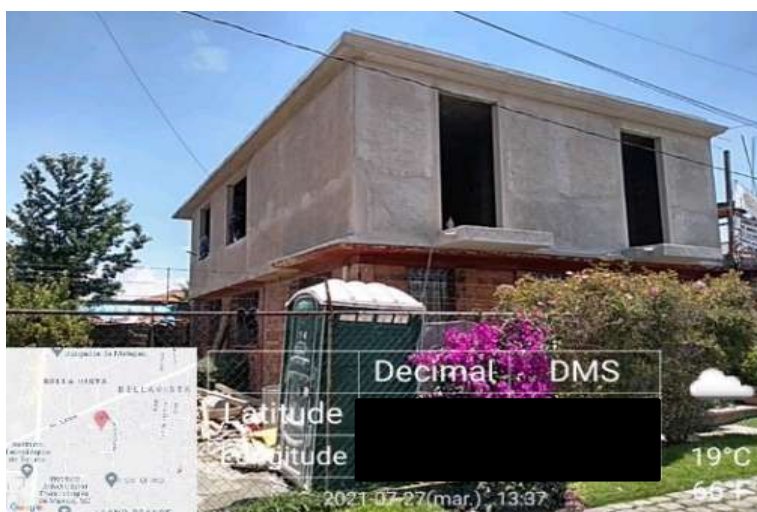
Fachada de la vivienda con muros de primer nivel desplantados y repellados
